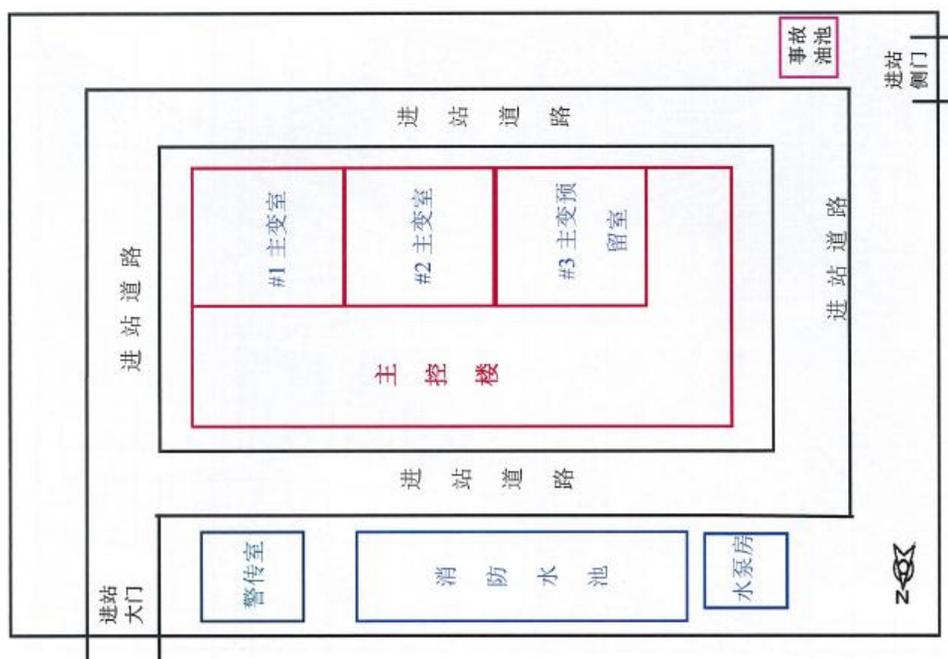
类比对象 110kV 南山湾变电站站址平面布置图
